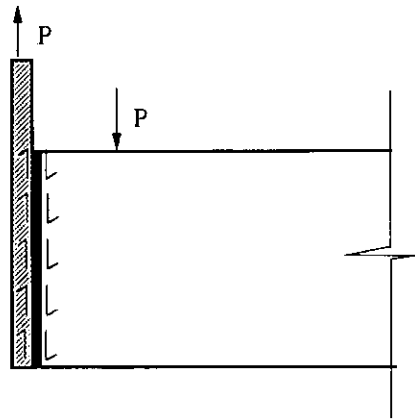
Transmissão da força aplicada na chapa para o concreto[04]
